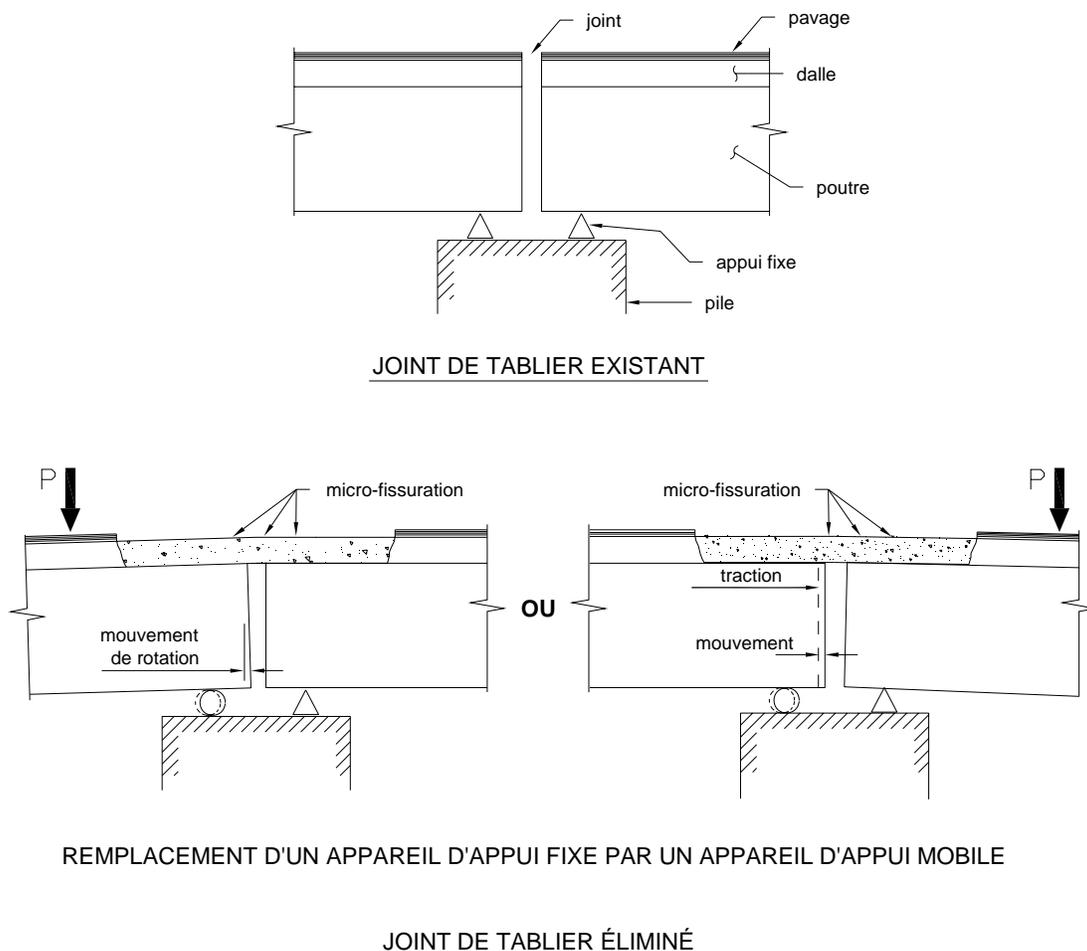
Élimination de joint de tablier – Mouvement de rotation des poutres
